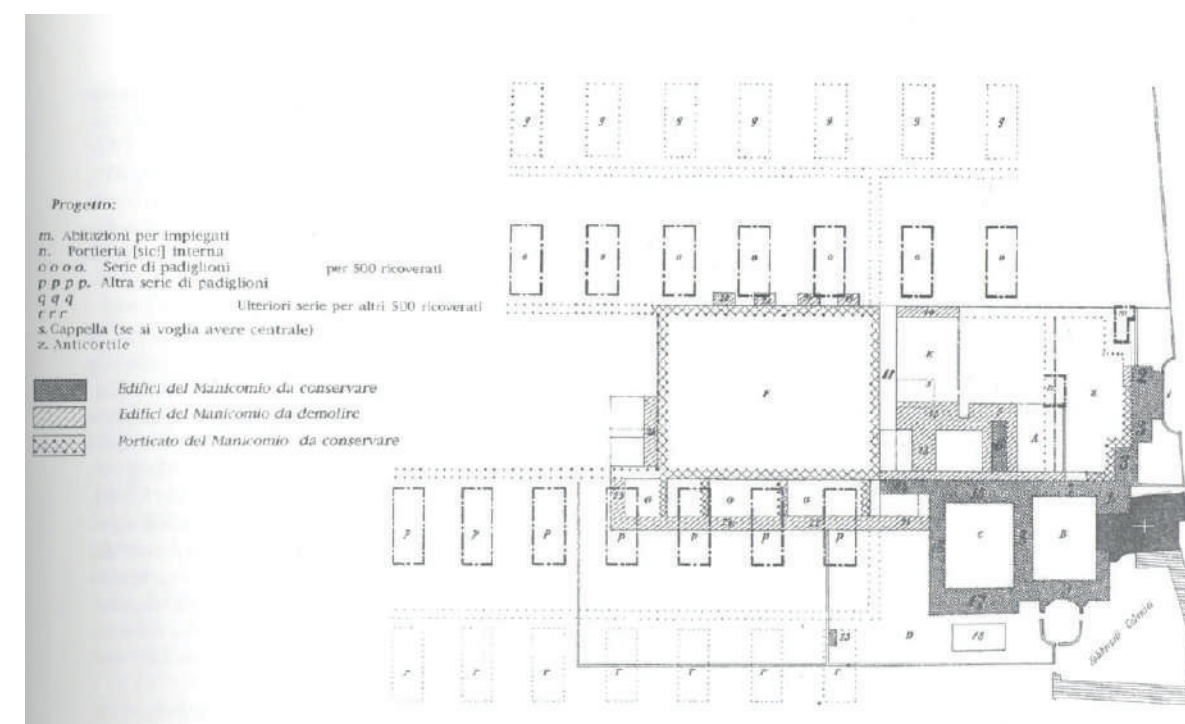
Progetto di Giovanni Battista Ferrante allegato alle Relazioni della Commissione per lo studio delle nuove fabbriche a Collegno 1883. Archivio Storico di Torino, Collezione Simeom.
